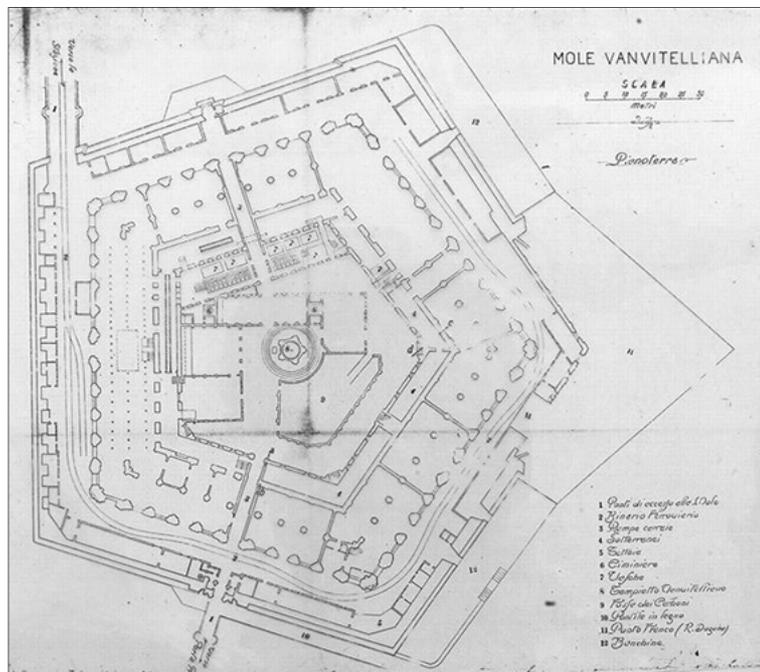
Pianta del piano terra. Prima metà del XX secolo
